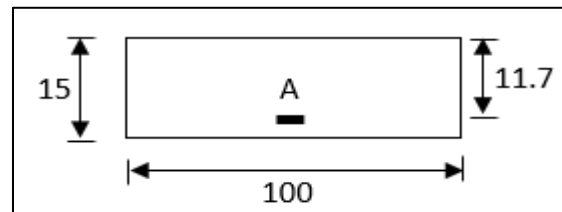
Section du calcul d'une dalle pleine sur appui
